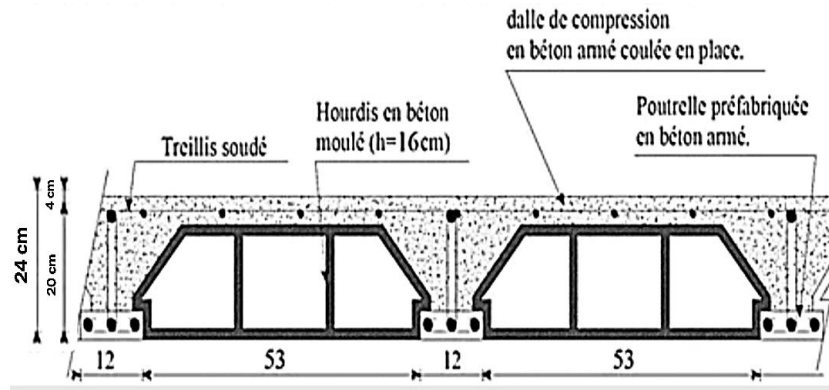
Coupe transversale d'un plancher en corps creux.
